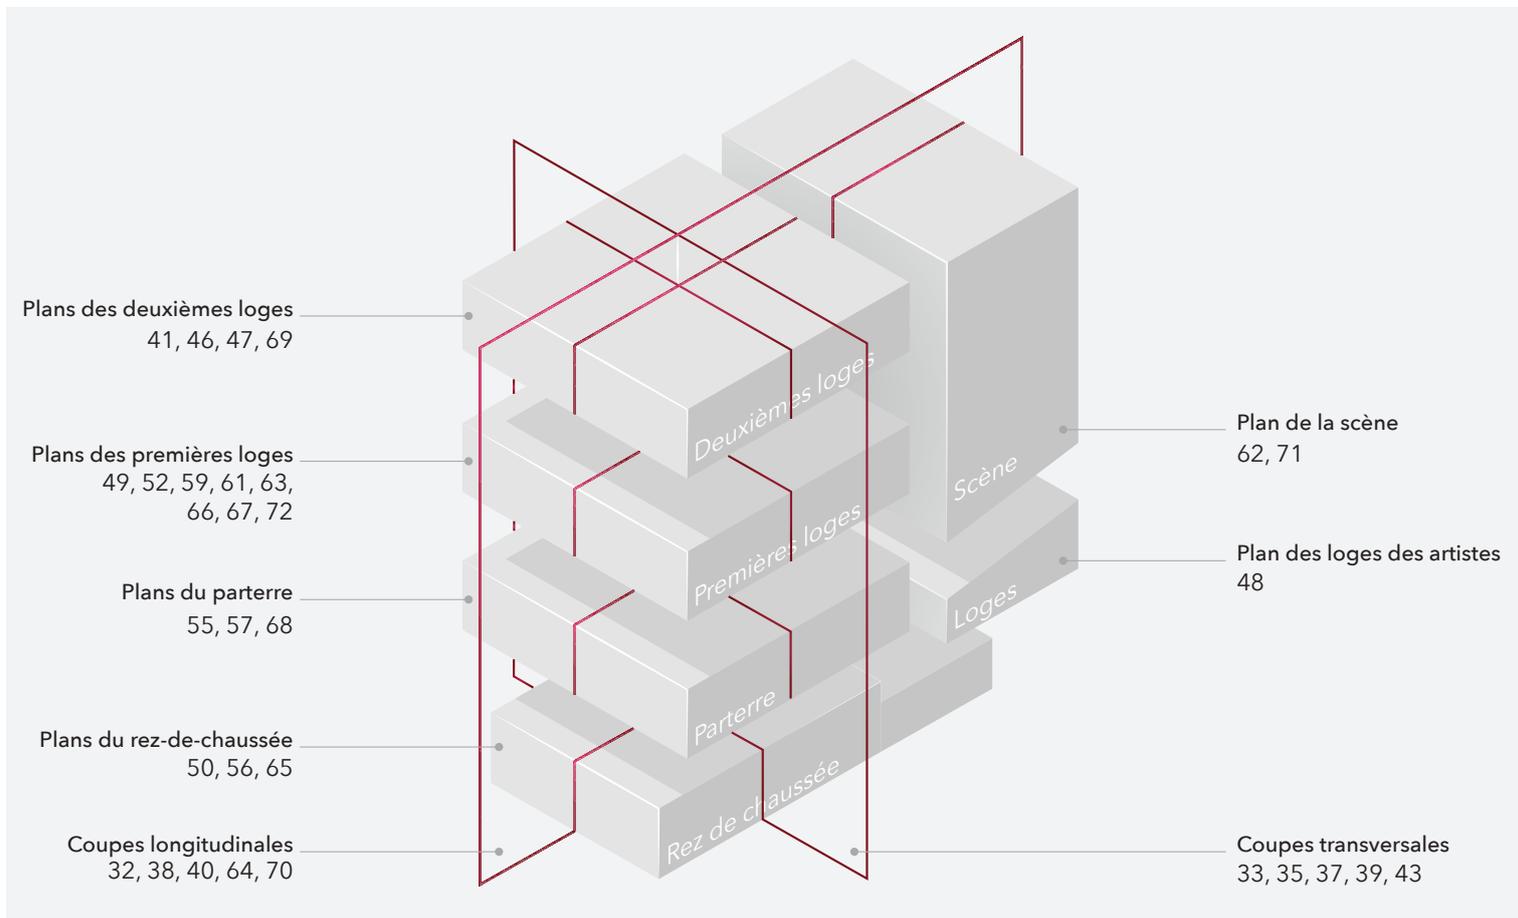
Schéma de positionnement des principaux plans et coupes du projet FSG-APD. Les numéros renvoient aux planches.
